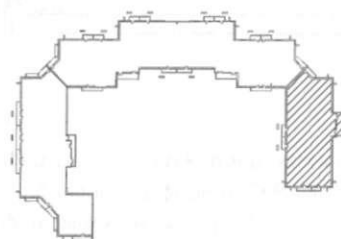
Раскладка второстепенных балок опалубки перекрытия на секцию типового этажа
